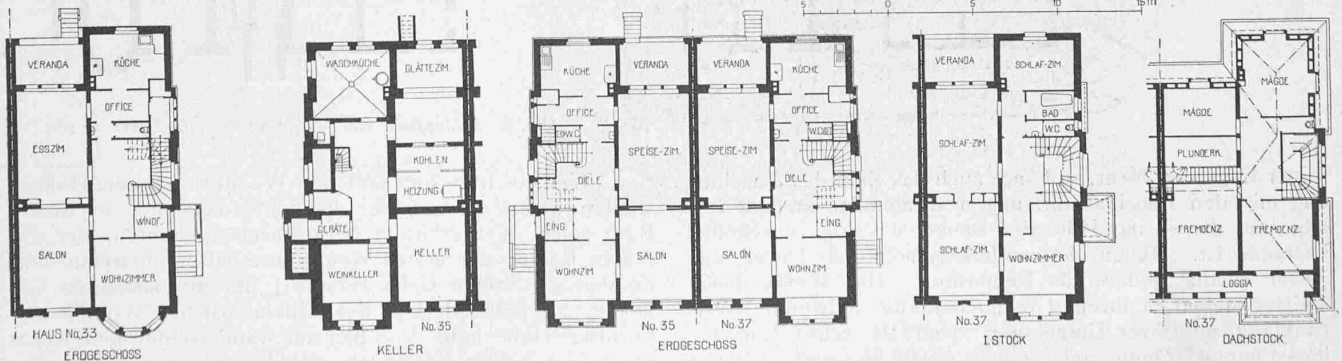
Grundrisse der Häuser Nr. 33, 35 und 37 an der Arnold Böcklinstrasse. — Masstab 1 : 400.
